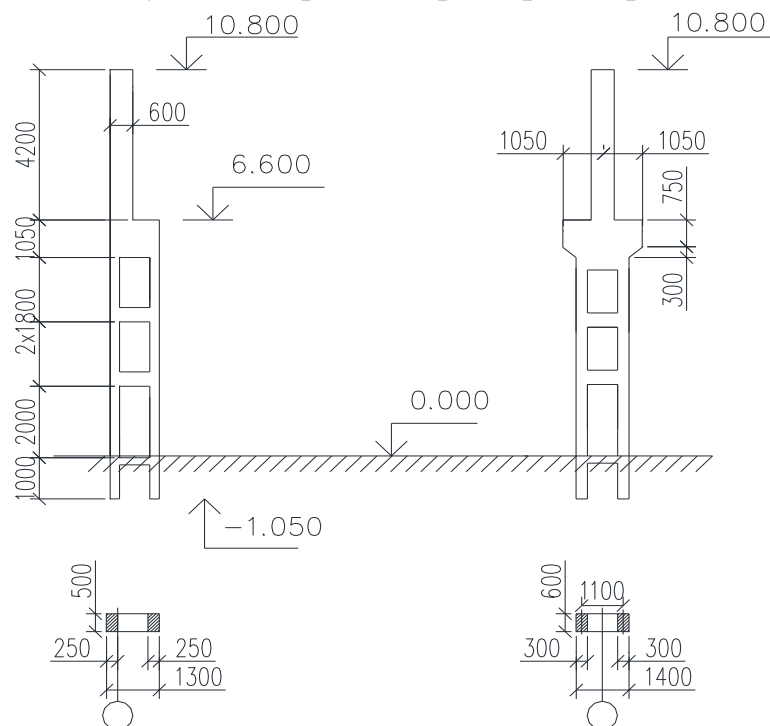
Двухветвевые железобетонные колонны каркаса здания
